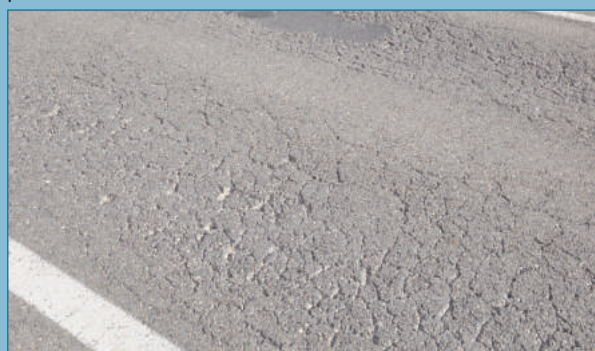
Grietas estructurales por fatiga de las capas granulares.
